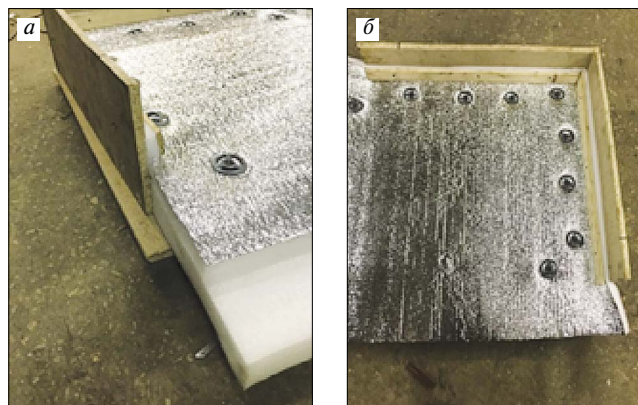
Пример выполнения узла примыкания «плавающего пола» к стене (а) и фиксации теплоизоляционного рулона к основанию (б)
